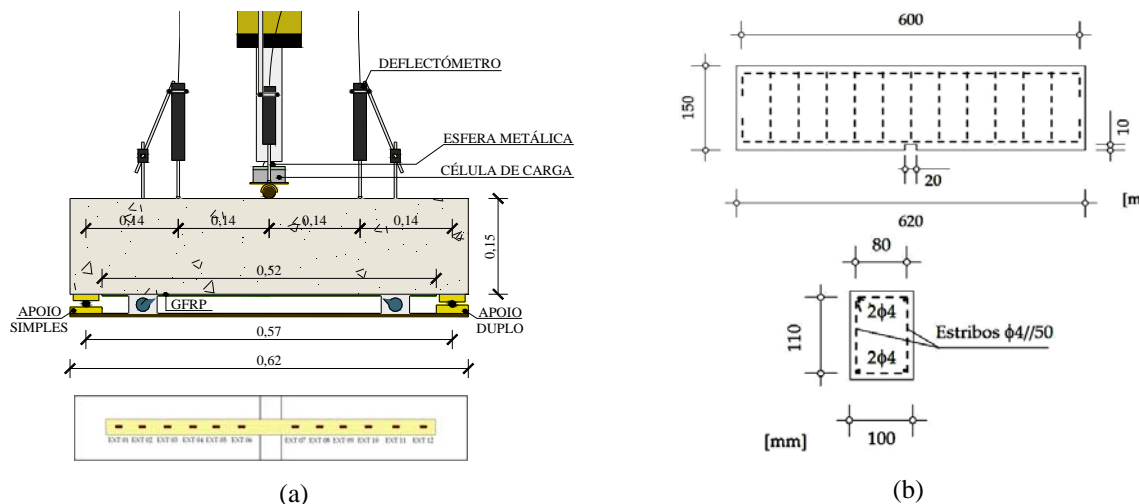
Ensaio de flexão. (a) Esquema de ensaio; (b) Pormenor das armaduras
